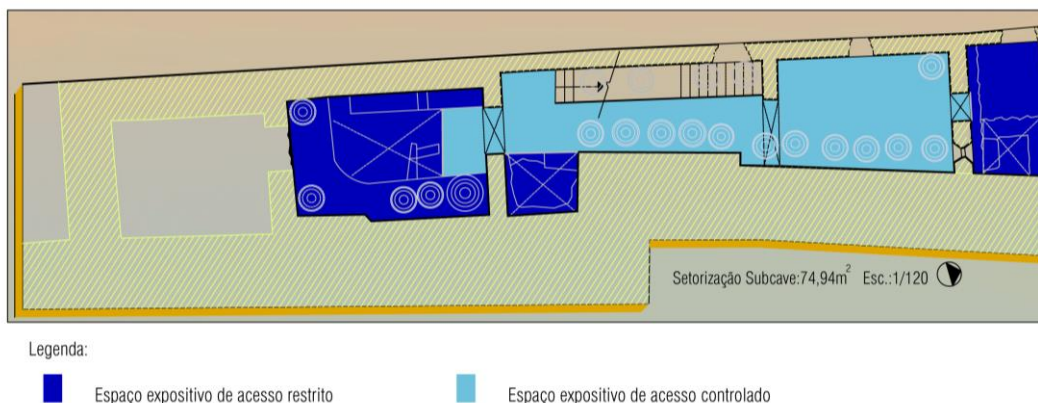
Sectorização de Uso: Casa das Talhas (subcave) – Esc.: 1:120
